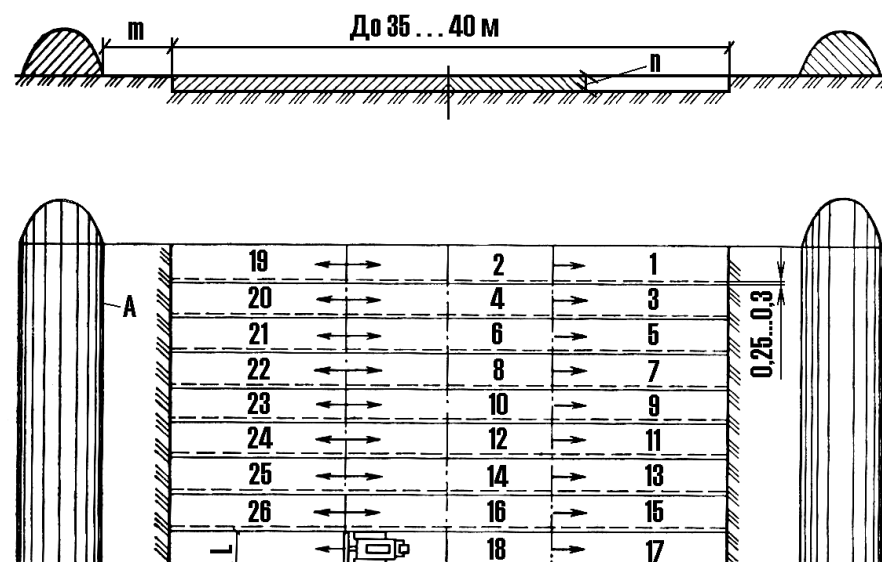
Поперечно-участковая схема снятия плодородного слоя бульдозером с неповоротным отвалом: n – толщина снимаемого слоя; m – полоса для движения машин; A – валы (бурты) грунта; L – ширина отвала бульдозера; 1–26 – проходы бульдозера
